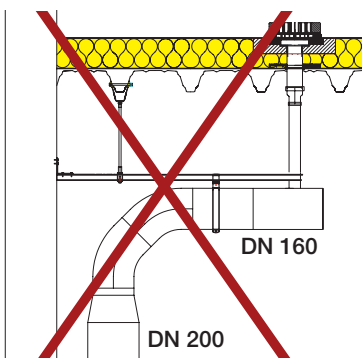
Falleitung größer (so darf nicht verbaut werden)
